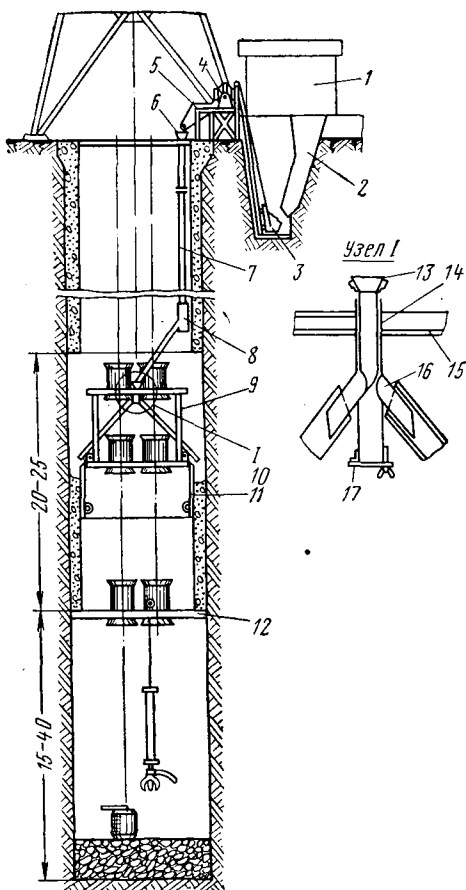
Параллельная схема проходки ствола с опалубкой, подвешенной к полку:
